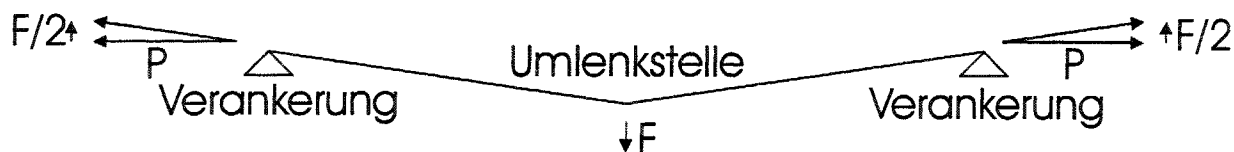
Rückstellkraft (Betrachtung des Grundrisses)
